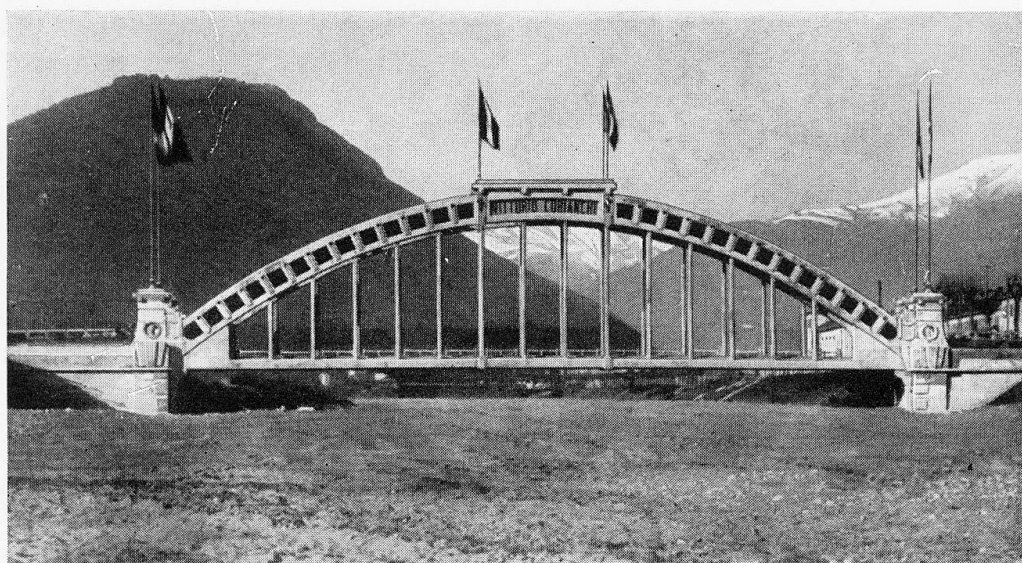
Pont ferroviaire à Intra = Eisenbahnbrücke bei Intra = Railway bridge at Intra.
